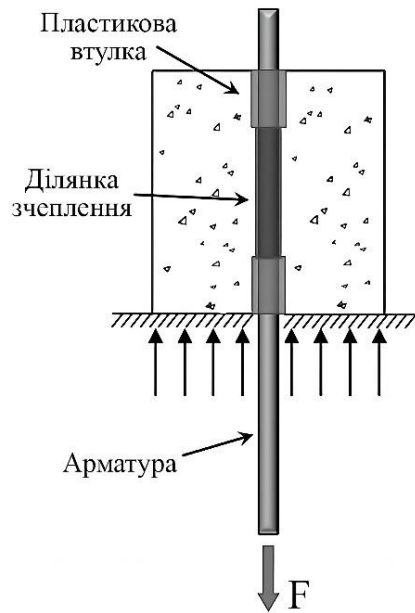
Схема випробування зчеплення арматури з бетоном на висмикування
